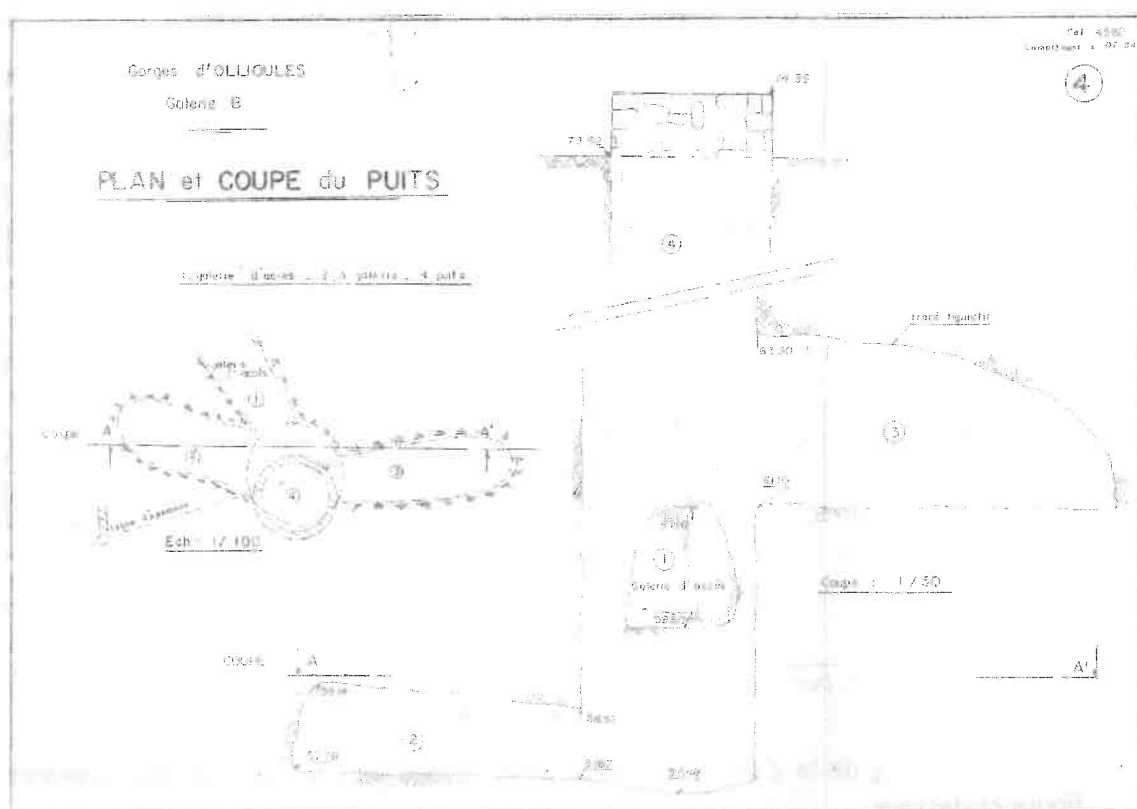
plan et coupe du puits (source : Cabinet BUET)
